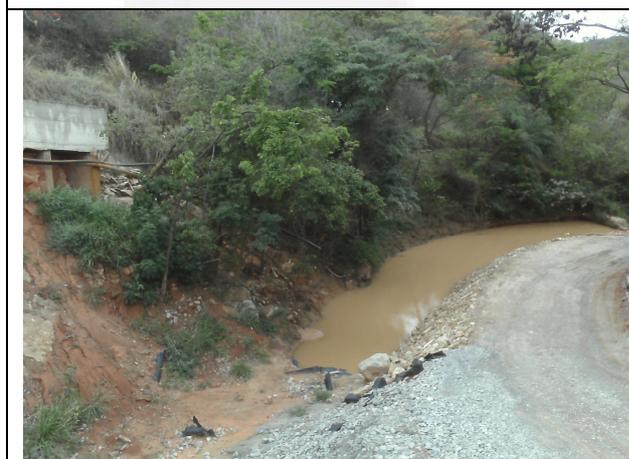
Lançamento da drenagem pluvial e drenagem de fundo do aterro, dique de contenção de sedimentos
